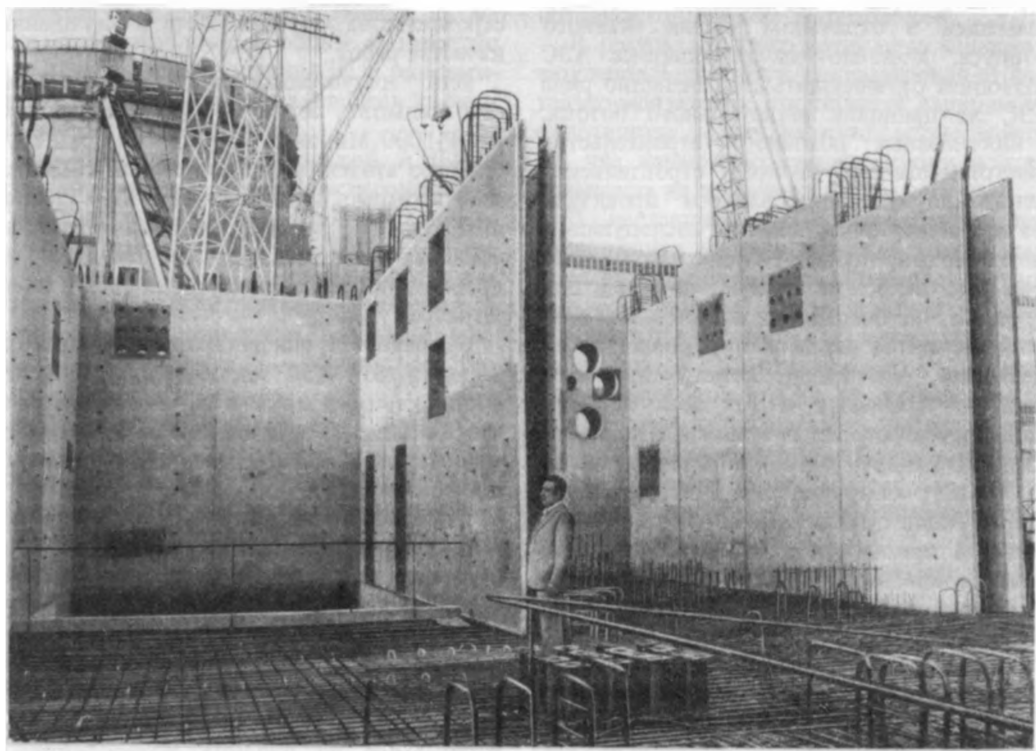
Монтаж железобетонных блок-ячеек на Запорожской АЭС
